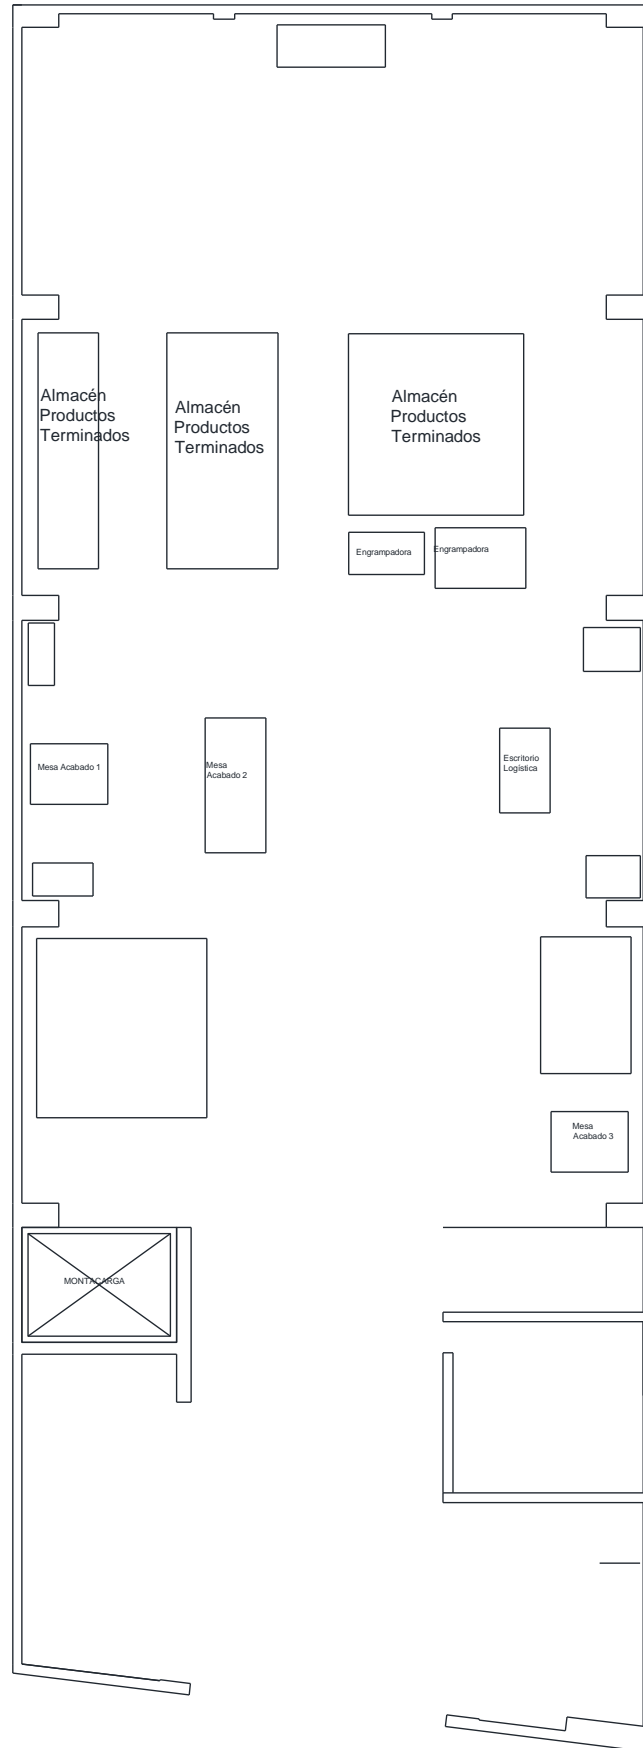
Layout propuesto de la planta 1 - primer piso.
